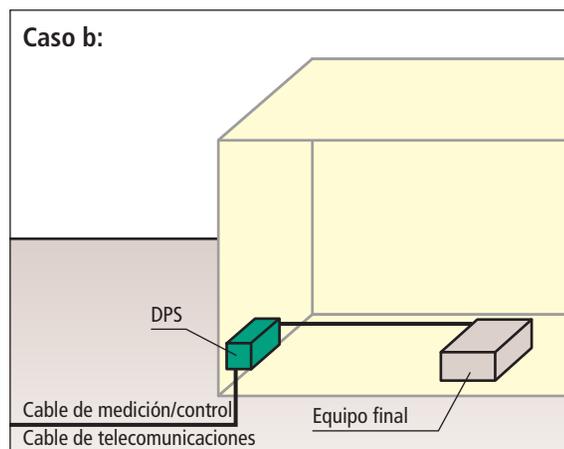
Edificio sin protección externa contra rayos y cables que salen fuera del edificio.
